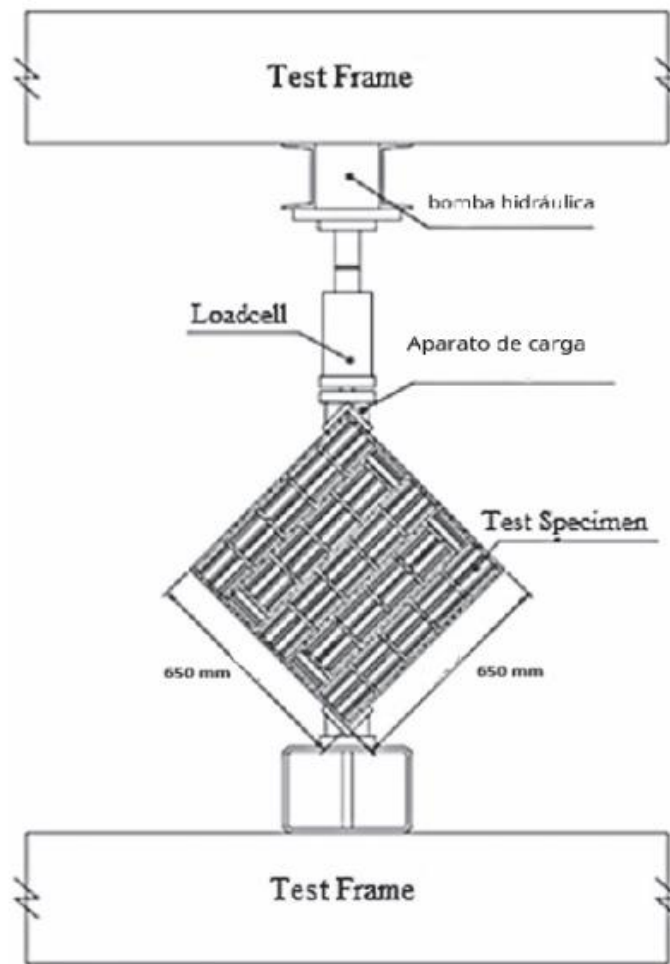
Vista esquemática de la configuración de prueba y la instrumentación.
